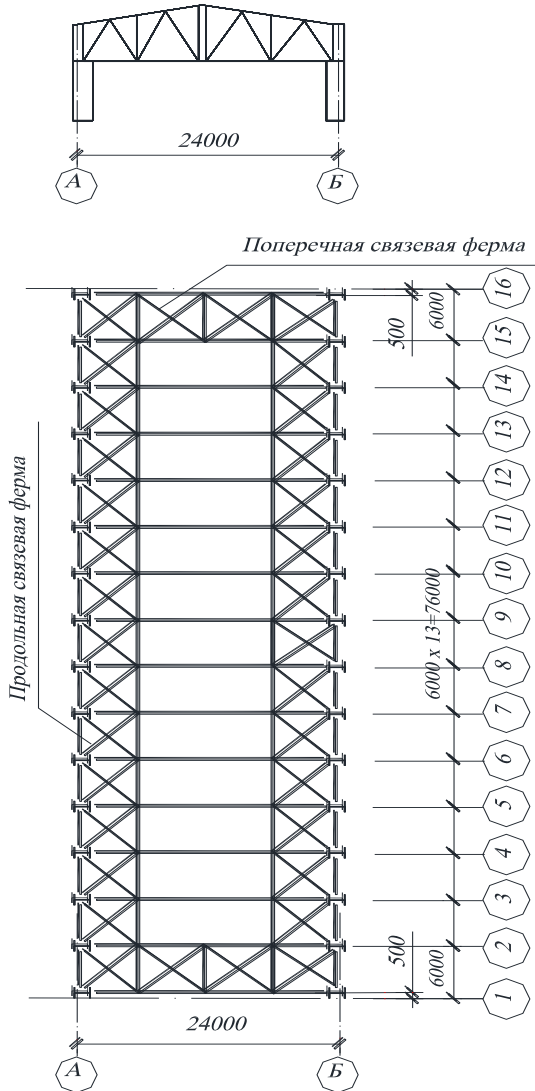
Схема связей по нижним поясам стропильных ферм двухпролетного промышленного здания
